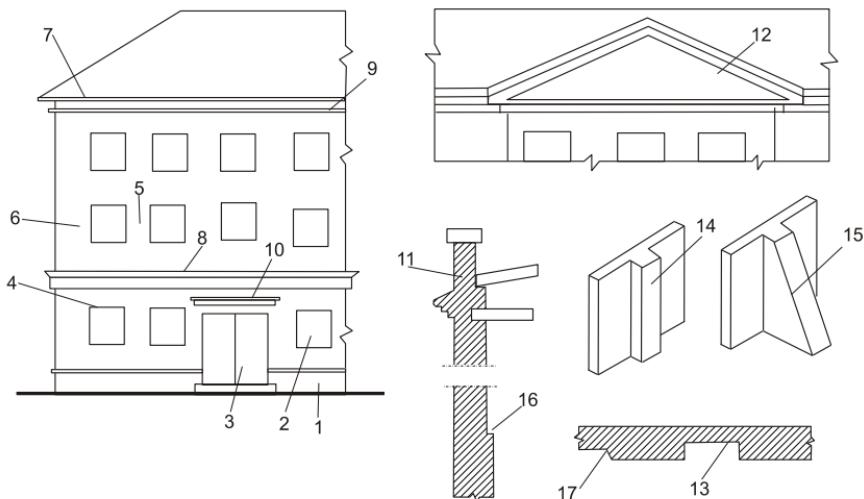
Архитектурно-конструктивные компоненты стен: 1 — цоколь; 2 — оконный проем; 3 — дверной проем; 4 — перемычки; 5 — простенок рядовой; 6 — то же, угловой; 7 — карниз венчающий; 8 — то же, промежуточный; 9 — поясок; 10 — сандрик; 11 — парапет; 12 — фронтон; 13 — ниша; 14 — пилястра; 15 — контрфорс; 16 — обрез; 17 — раскреповка
